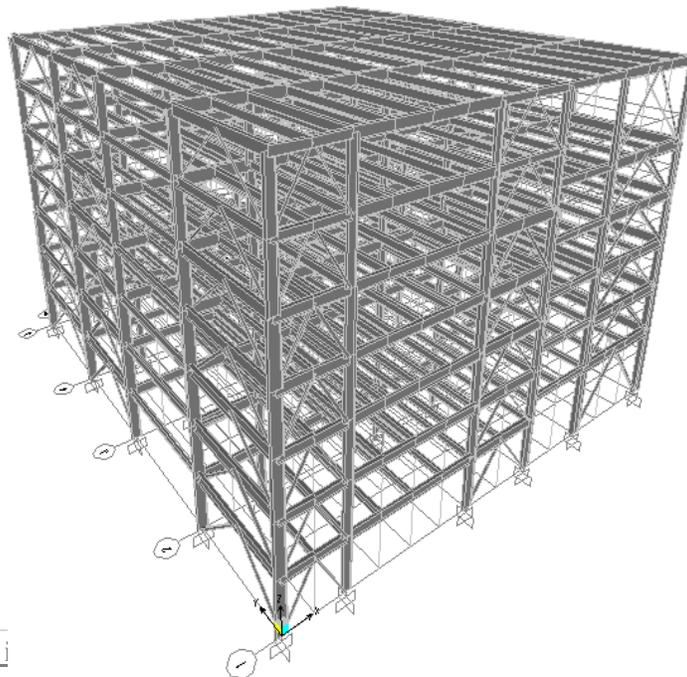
Hasil plotting struktur bressing, balok, dan kolom 1 pada lantai 2.
